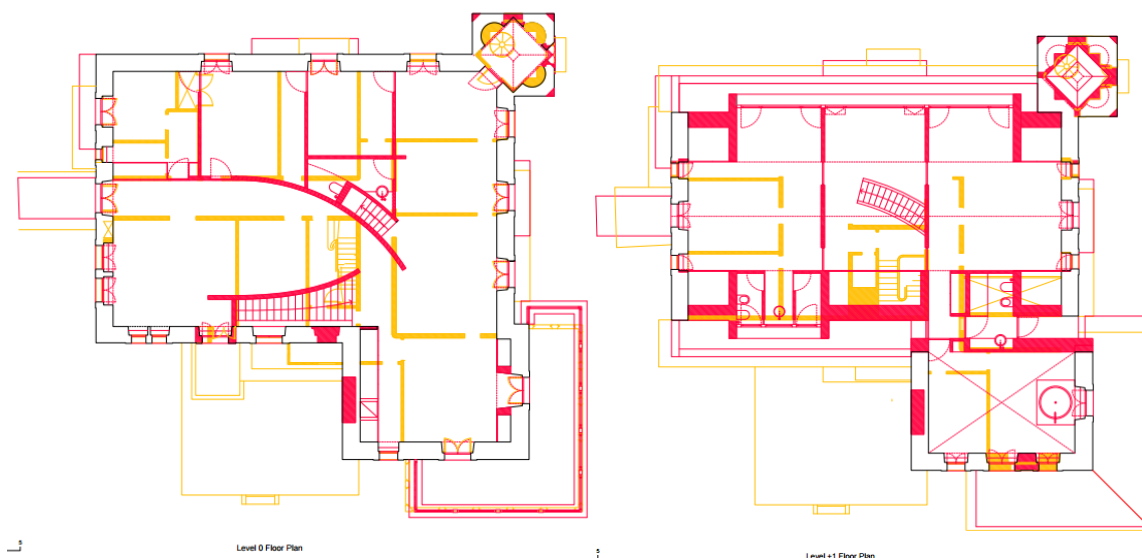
Plantas de alterações proposta (“vermelhos e amarelos”)
